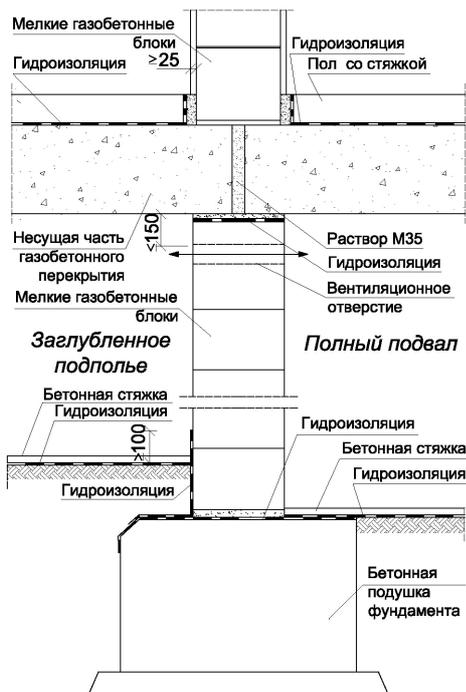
Опираие газобетонных плит перекрытия на внутреннюю стену из мелких блоков
